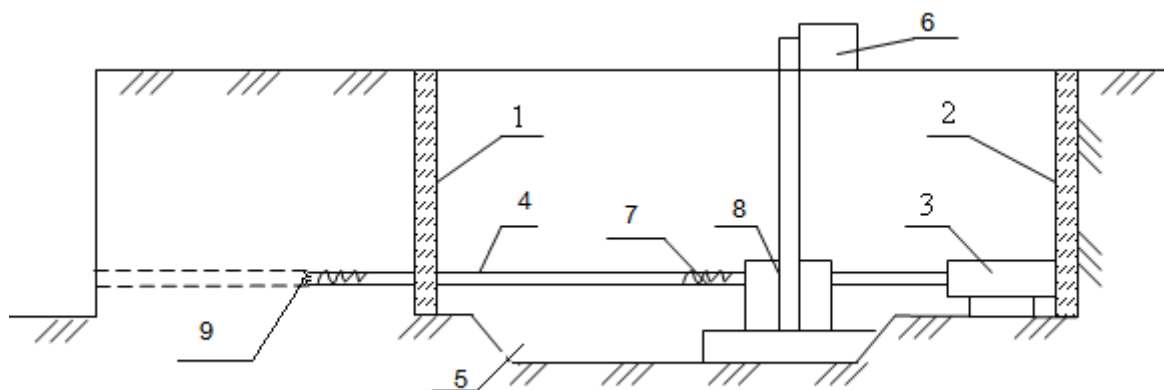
Продавливание: 1 - крепление передней стенки котлована; 2 - упор на задней стенке котлована; 3 - гидравлический домкрат; 4 - труба; 5 - приямок для наращивания трубы; 6 - привод; 7 - шнековое устройство для извлечения грунта; 8 - рама, передающая давление; 9 - режущий наконечник
